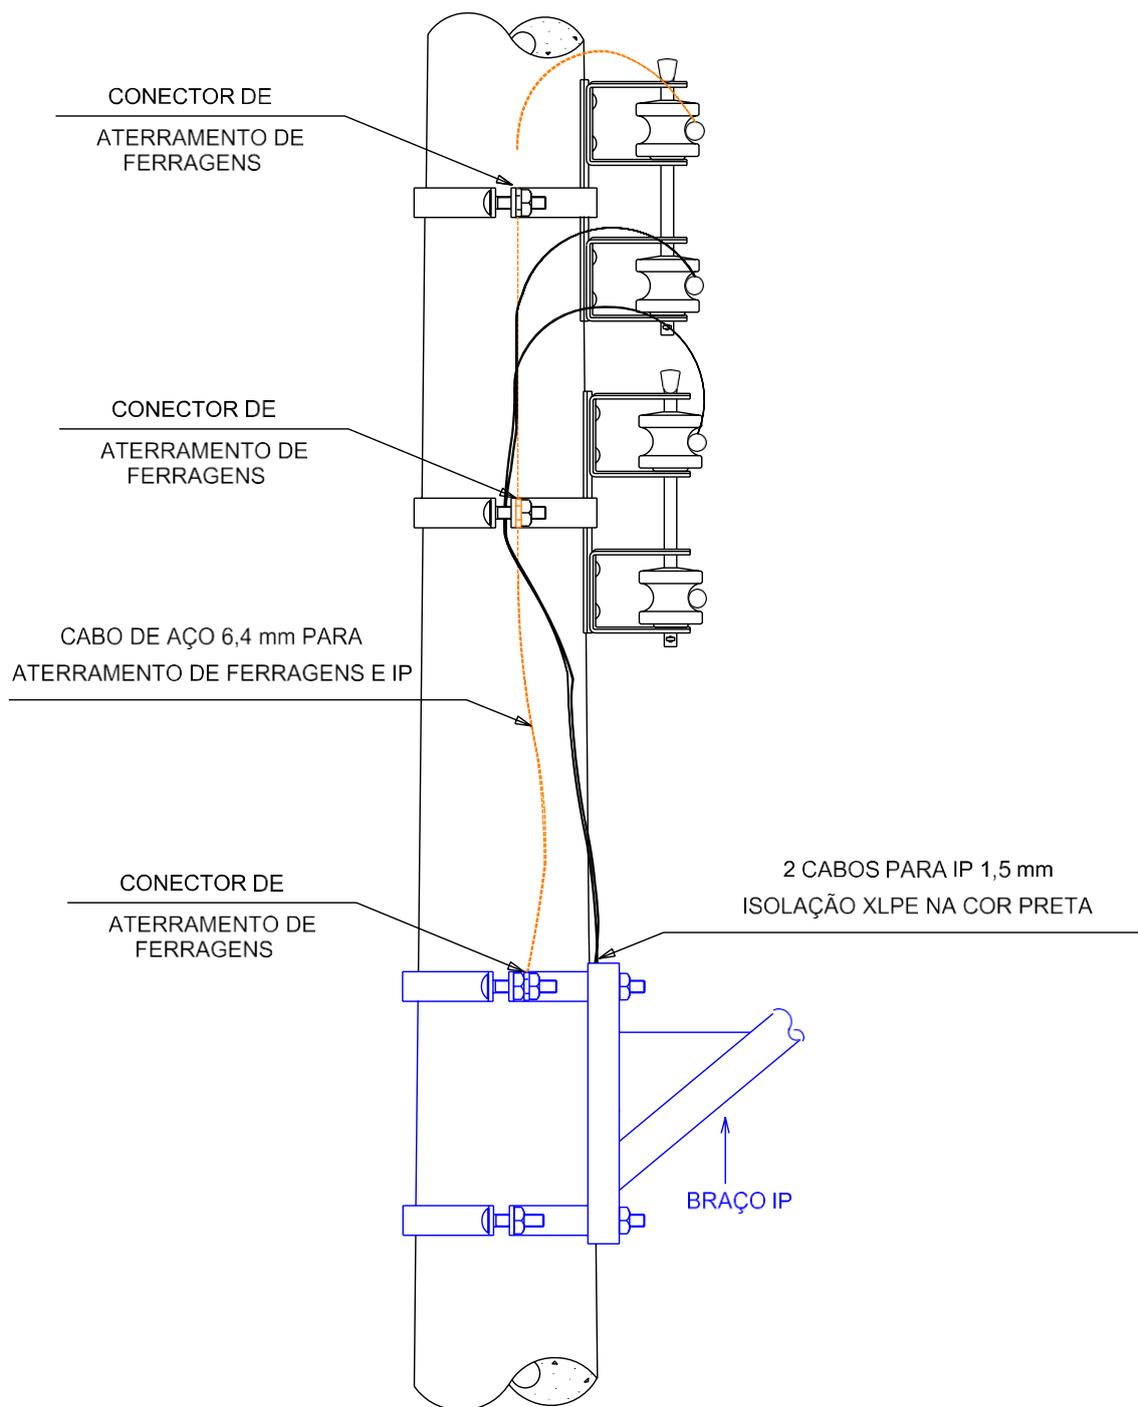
Aterramento Definitivo de Ferragens e Conexão de Equipamentos de IP em Rede Nua
